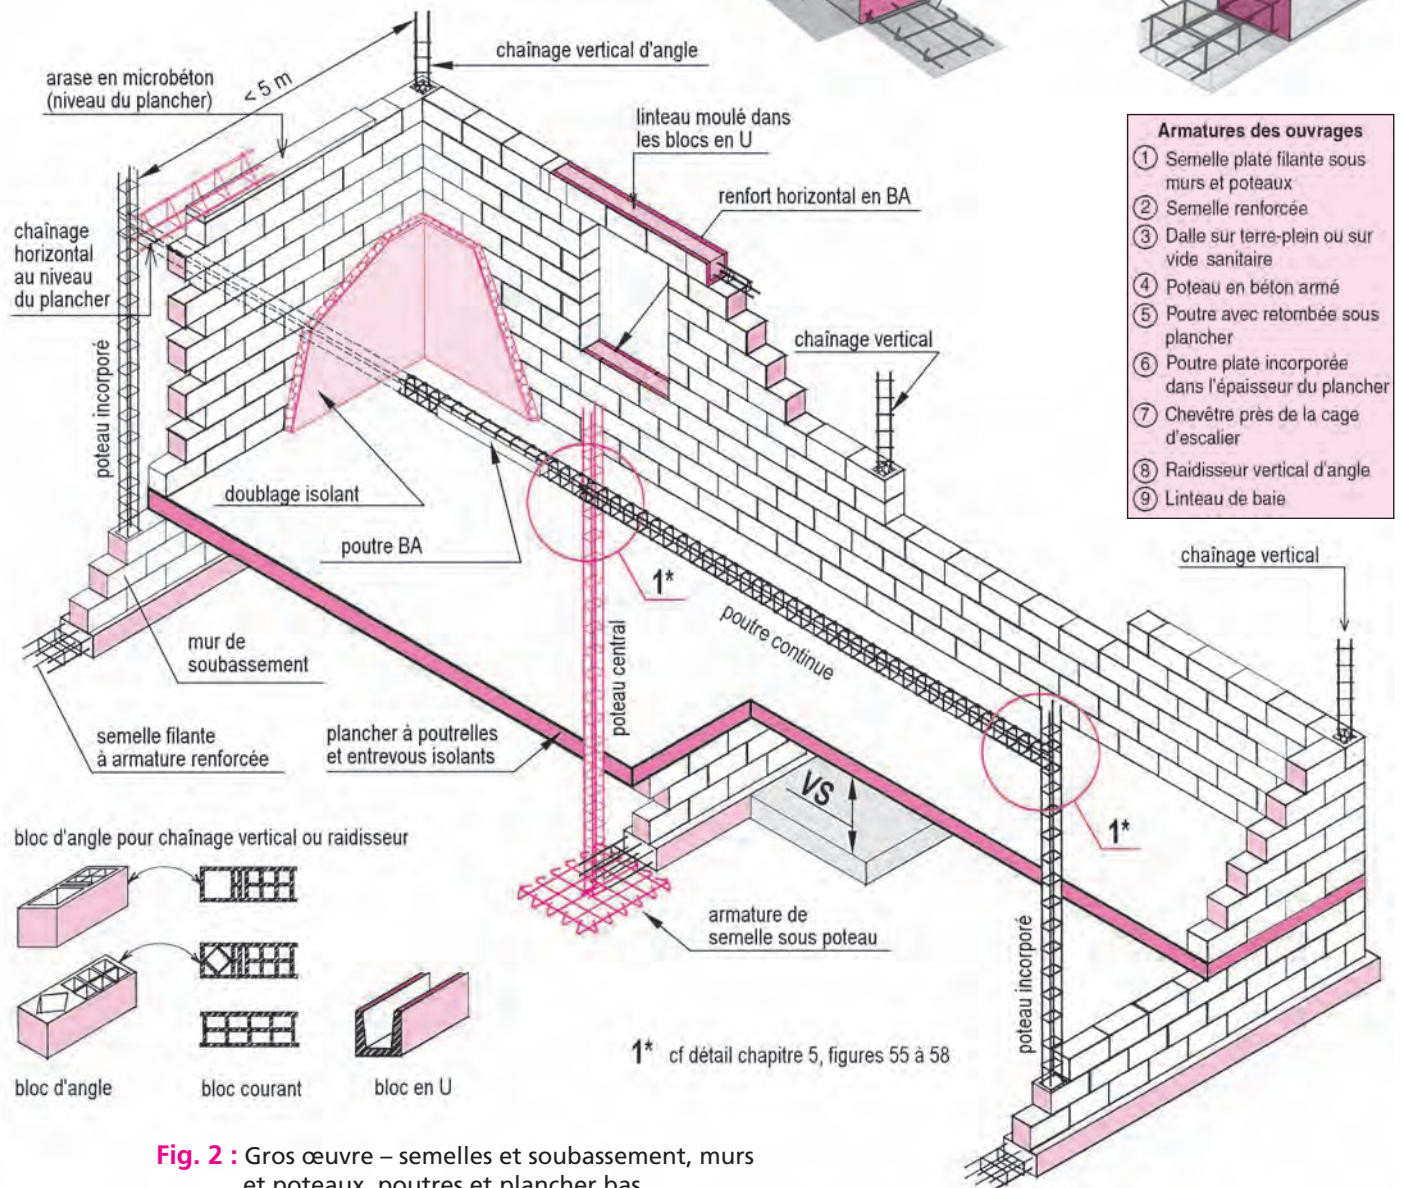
Gros œuvre – semelles et soubassement, murs et poteaux, poutres et plancher bas
